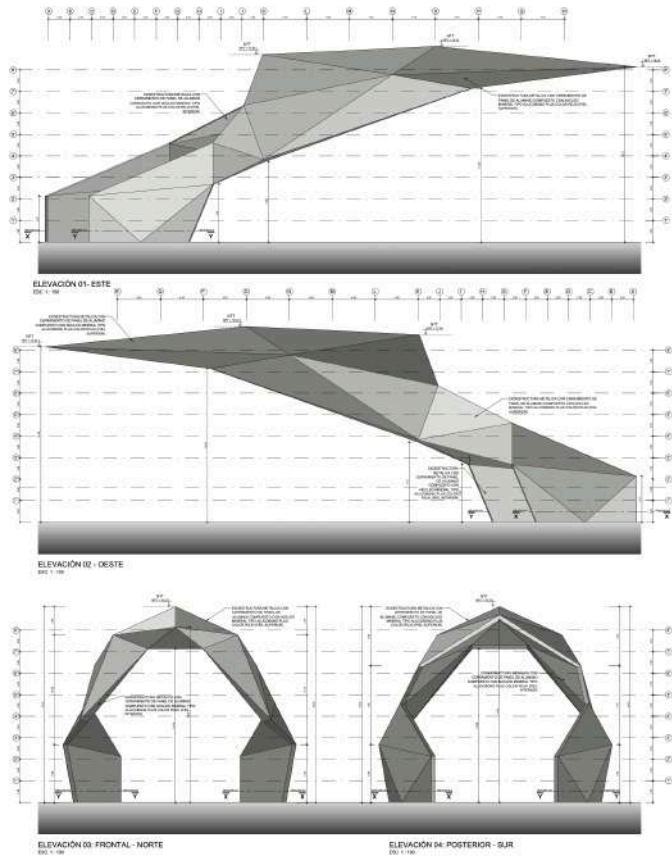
ELEVACIÓN NORTE CCAUJ
